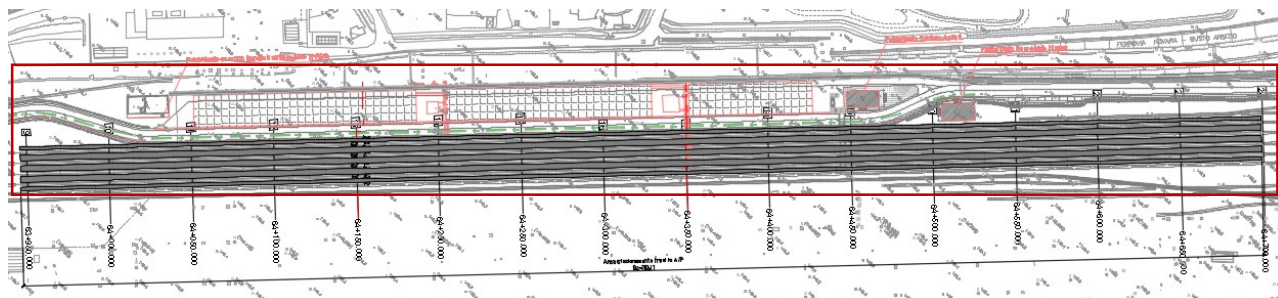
Planimetria generale dell' opera – Platee e fondazioni sottobinari
